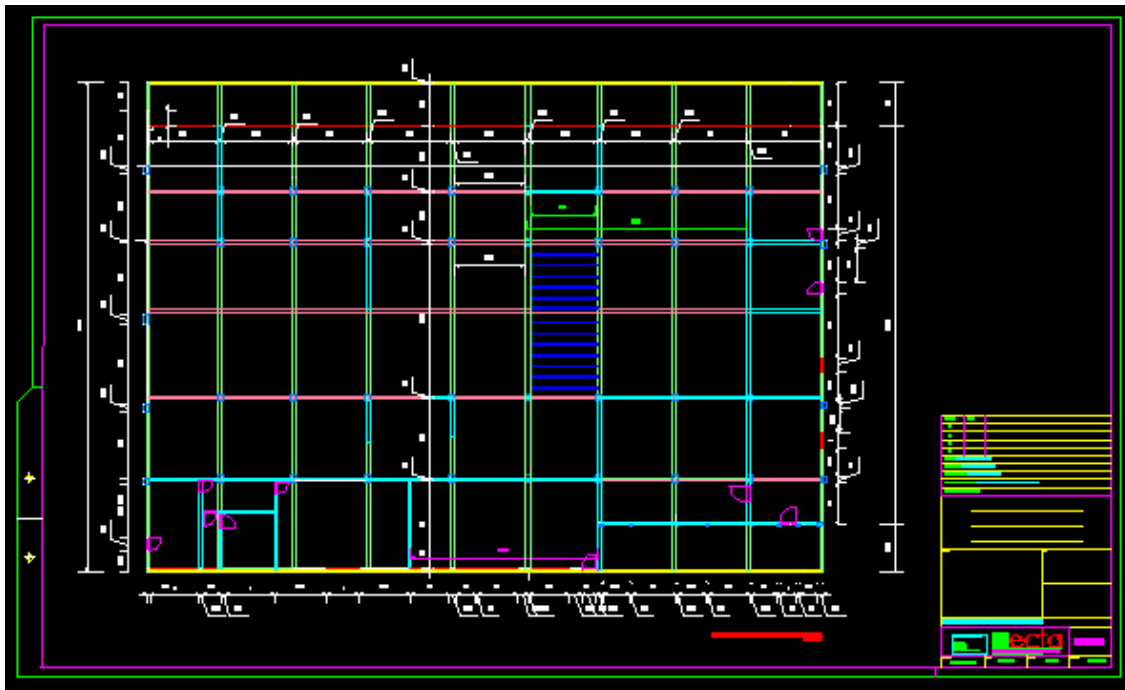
Planta baixa do projeto arquitetônico *as built*. (Fonte: ECTA engenharia)
